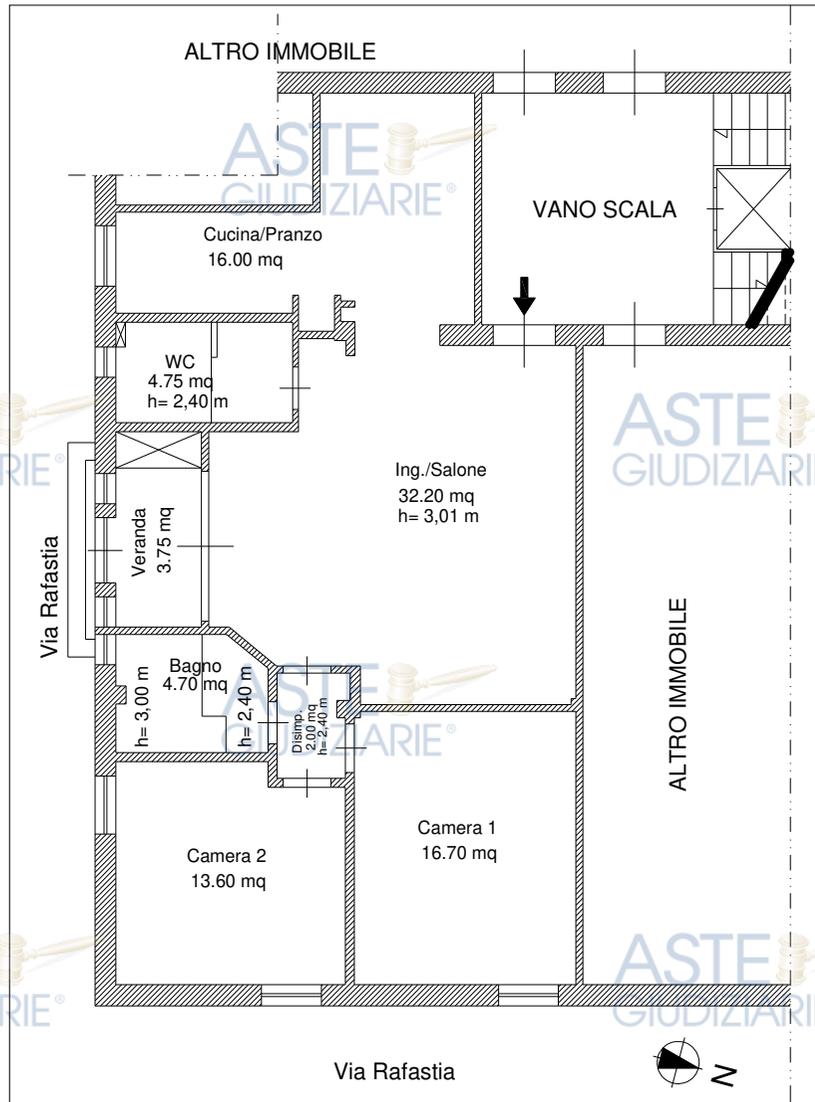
Pianta dell'abitazione pignorata – piano terzo (Lotto 5)
